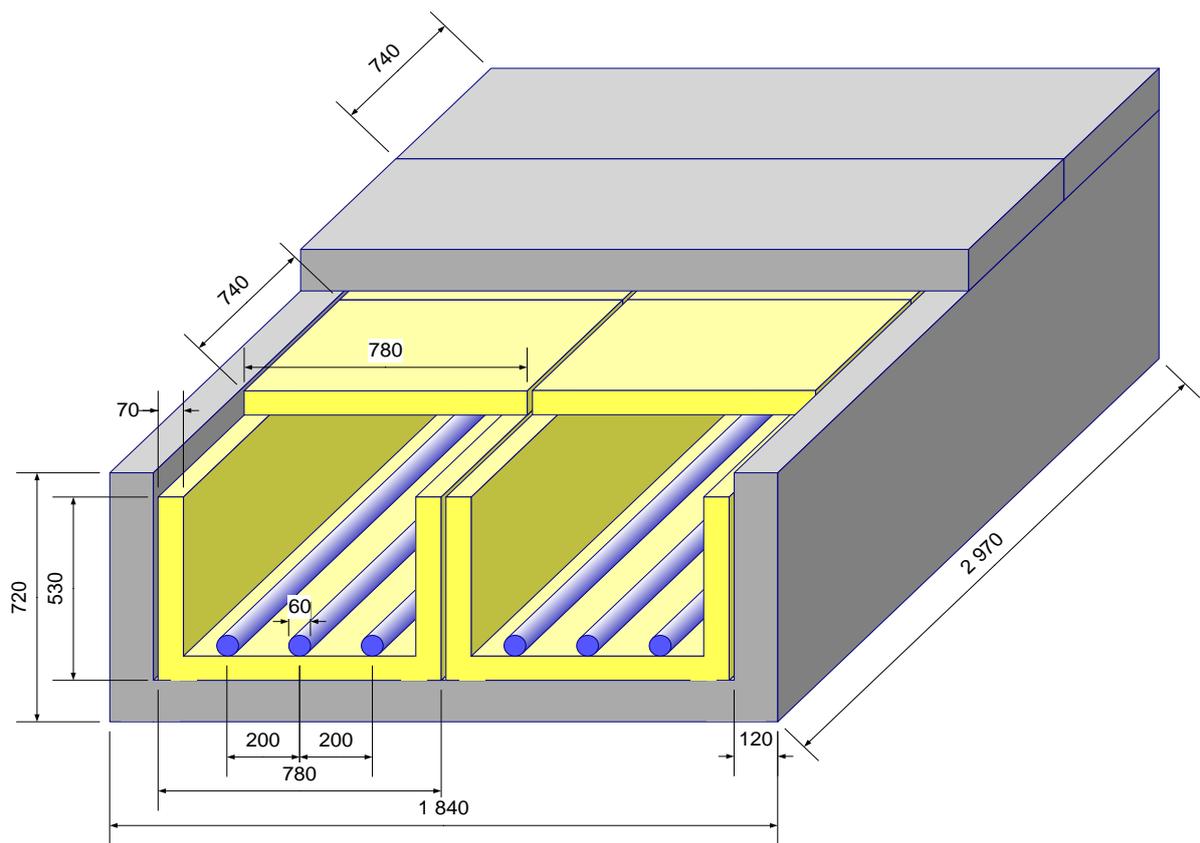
Прокладка двухцепной кабельной линии в железобетонных лотках
